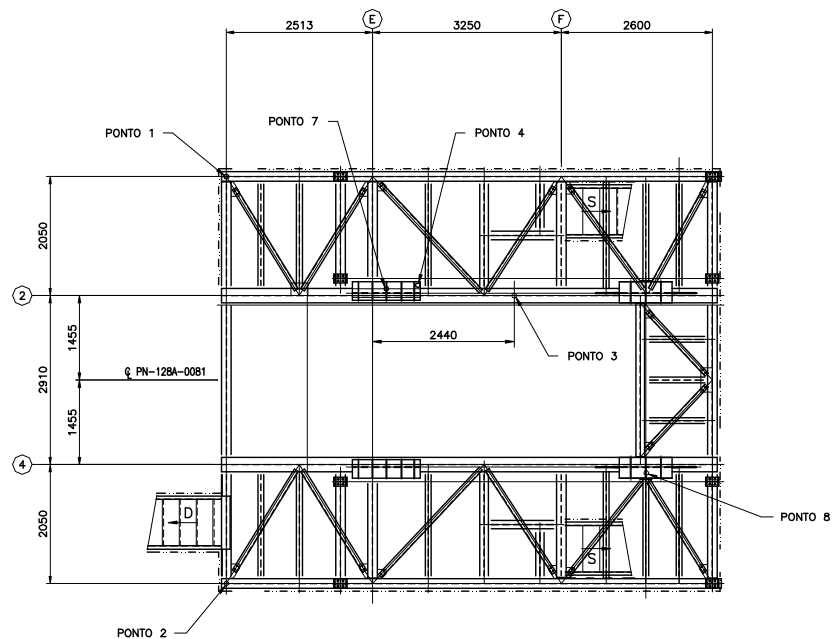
Localização dos pontos - Plataforma da Elevação 872025.
